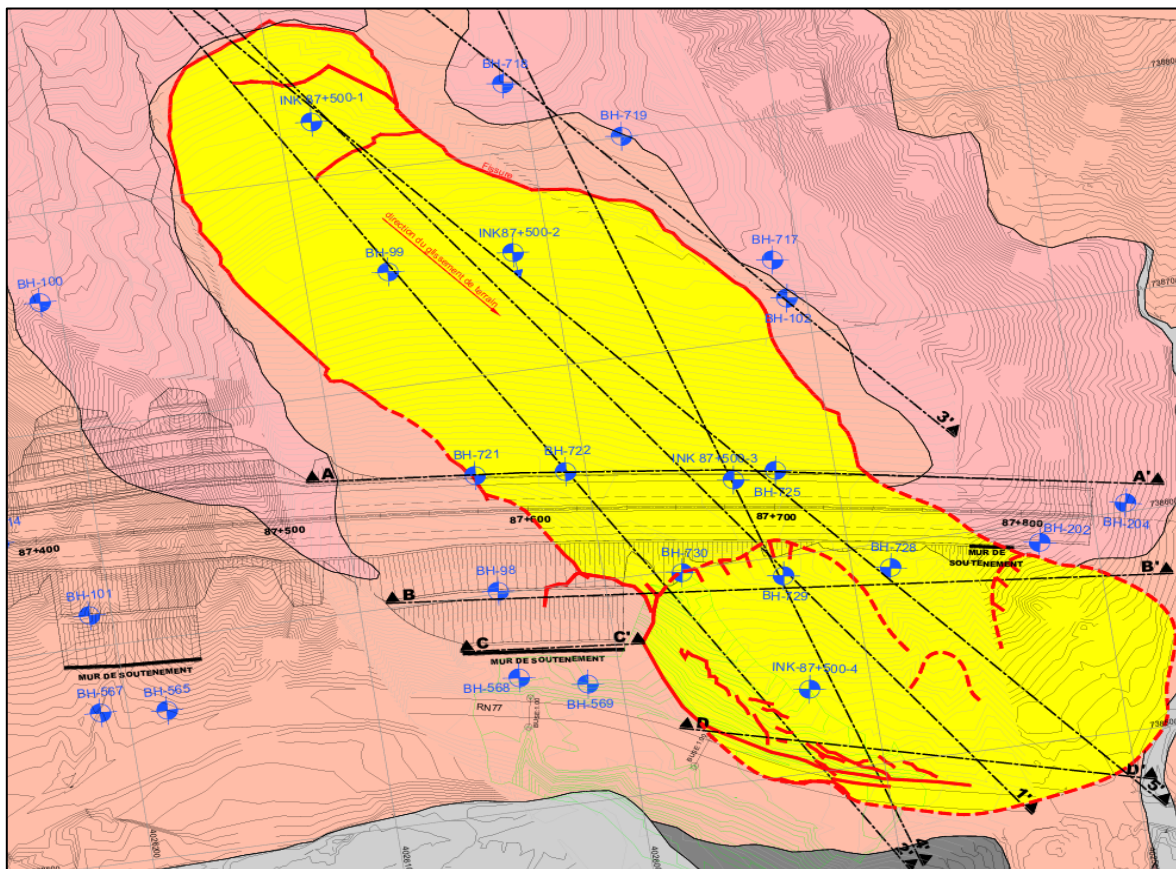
Plan d'implantation des sondages et d'inclinomètre
